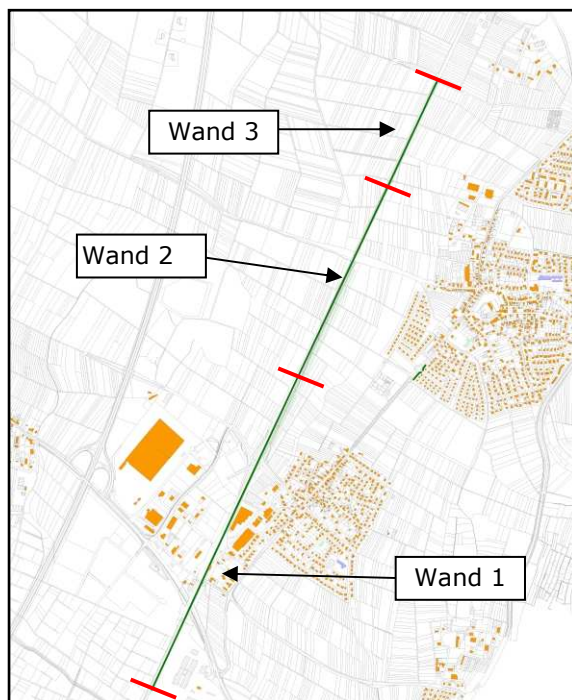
Lärmschutzwände - Bestand 2008 Variante 3
